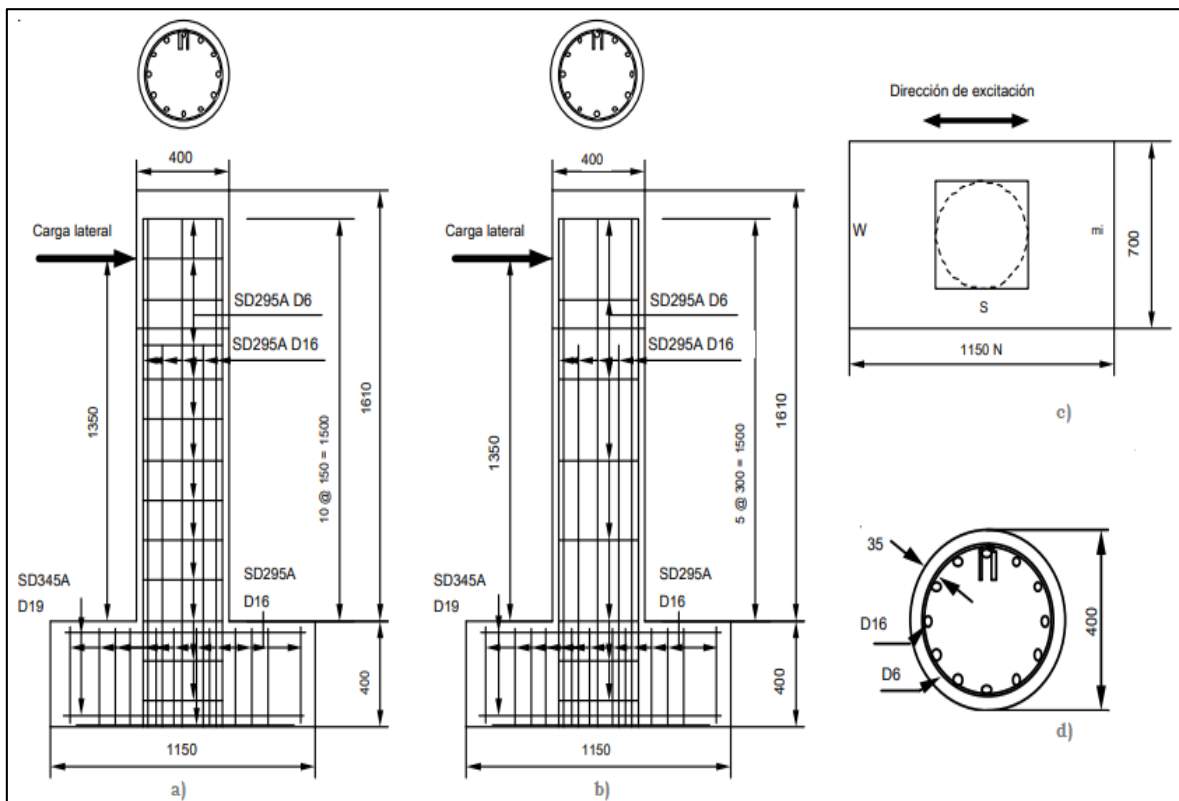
Las muestras de columna para prueba de carga cíclica: (a) muestra A1-A3, (b) B1-B3 espécimen, (c) vista superior, y la sección (d) (Kawashima et al., 2000)
